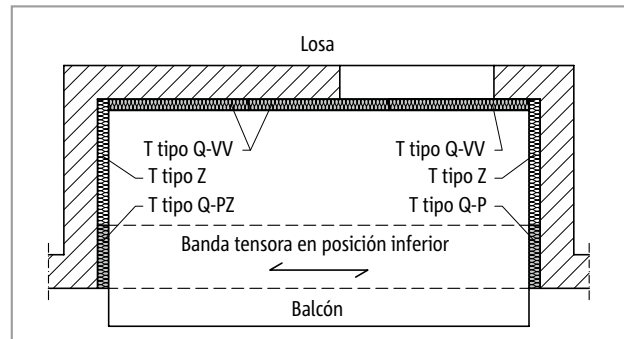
Schöck Isokorb® T tipo K: Logia con apoyo en tres lados y banda tensora
